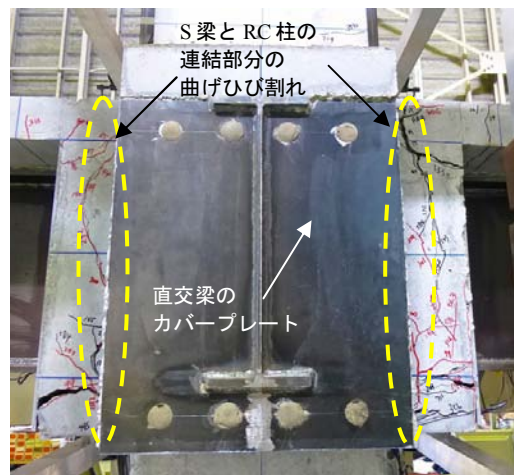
ひび割れ発生状況 (S36:R=+20×10⁻³rad)
